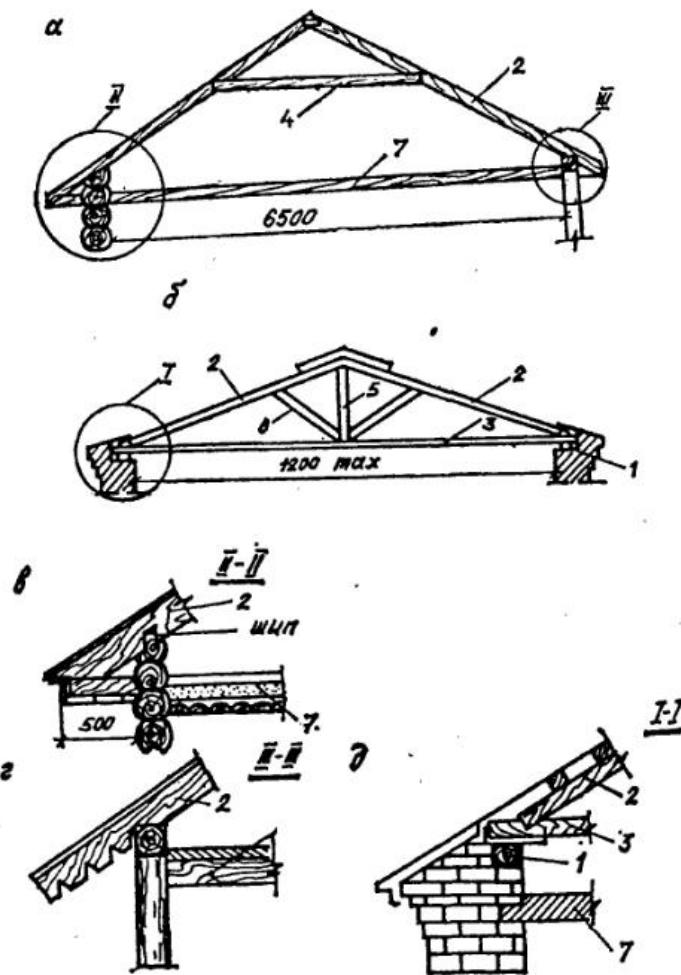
Виды стропил: а — наклонные; б — висячие; в — опирание стропил на сруб; г — опирание стропил на верхнюю обвязку в каркасных домах. 1 — мауэрлат; 2 — стропильная нога; 3 — затяжка; 4 — ригель; 5 — стойка; 6 — подкос; 7 — балка перекрытия.
